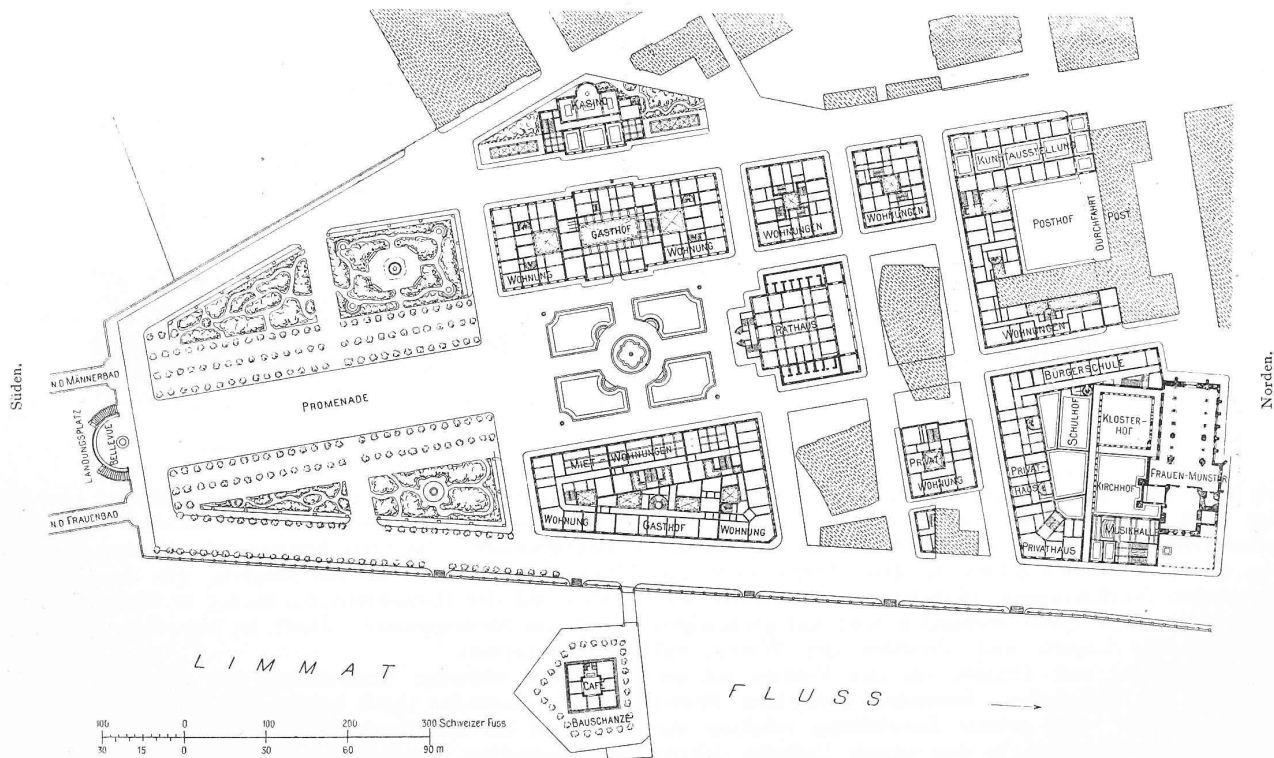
Variante zum Entwurf für eine Platzanlage im Krazquartier in Zürich. — Masstab 1 : 2500.
